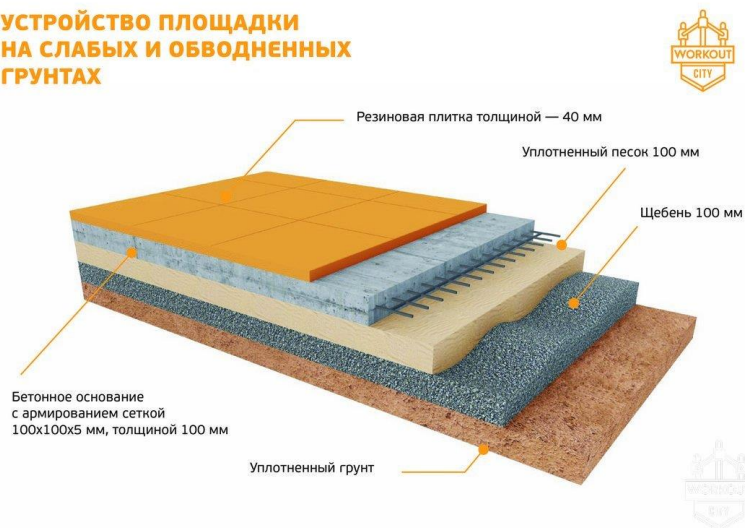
Бетонное основание с укладкой из резиновой плитки
